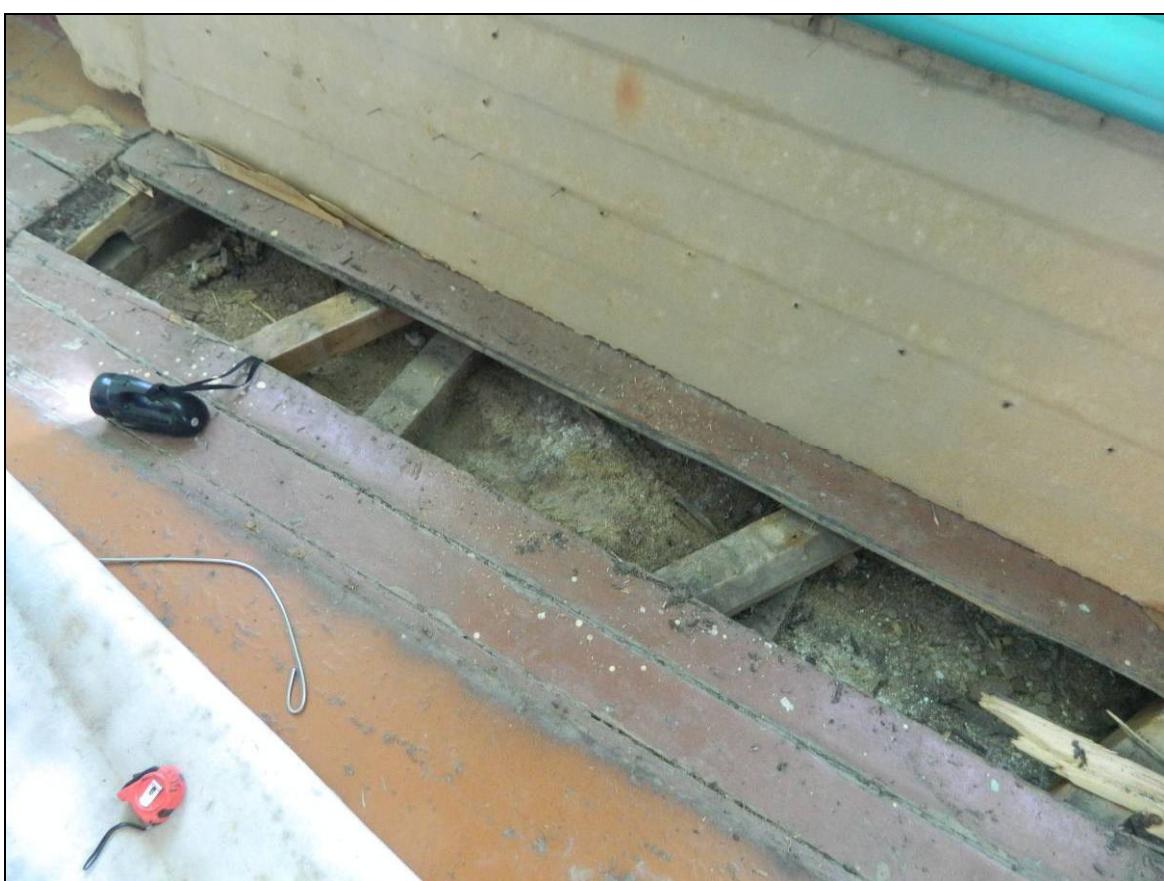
Фрагмент вскрытия пола 2-го этажа в осях «4-5/Д-Е»
